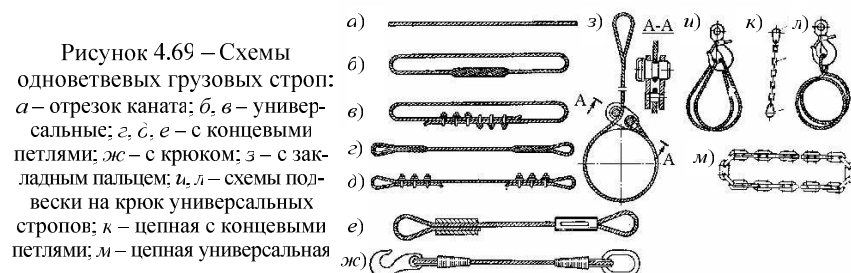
Схемы одноветвевых грузовых строп: а – отрезок каната; б, в – универсальные; г, д, е – с концевыми петлями; ж – с крюком; з – с закладным пальцем; и, л – схемы подвески на крюк универсальных стропов; к – цепная с концевыми петлями; м – цепная универсальная
